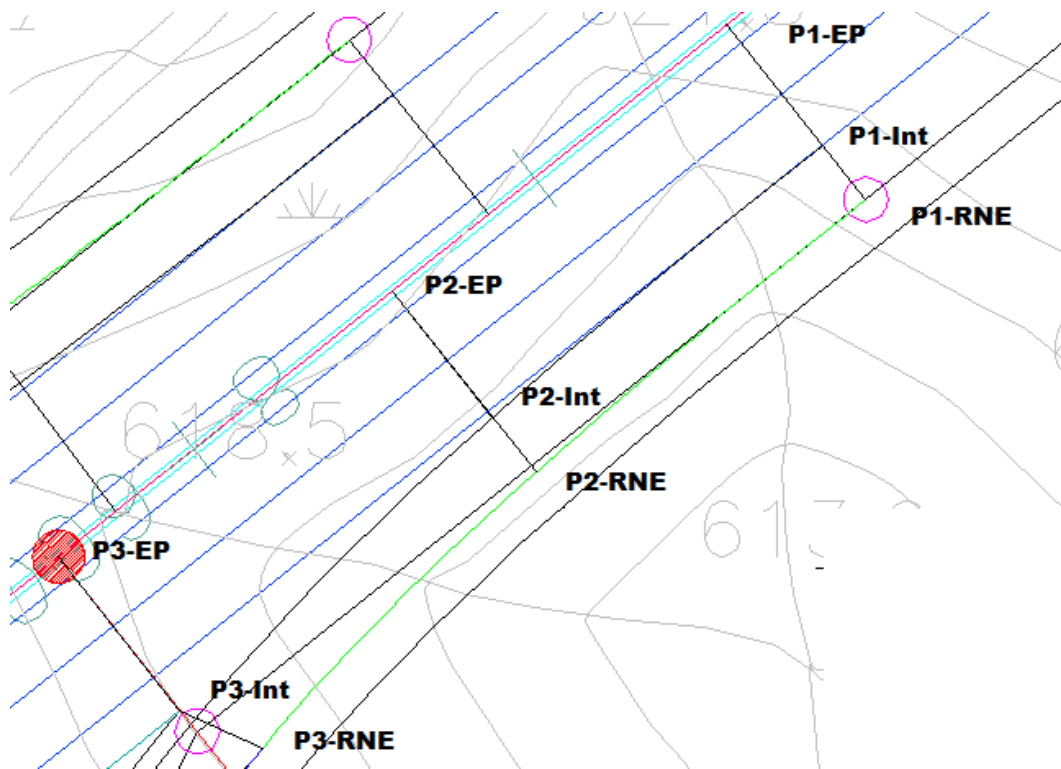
Pormenor dos Pontos de Estudo da Rasante do Ramo NE
